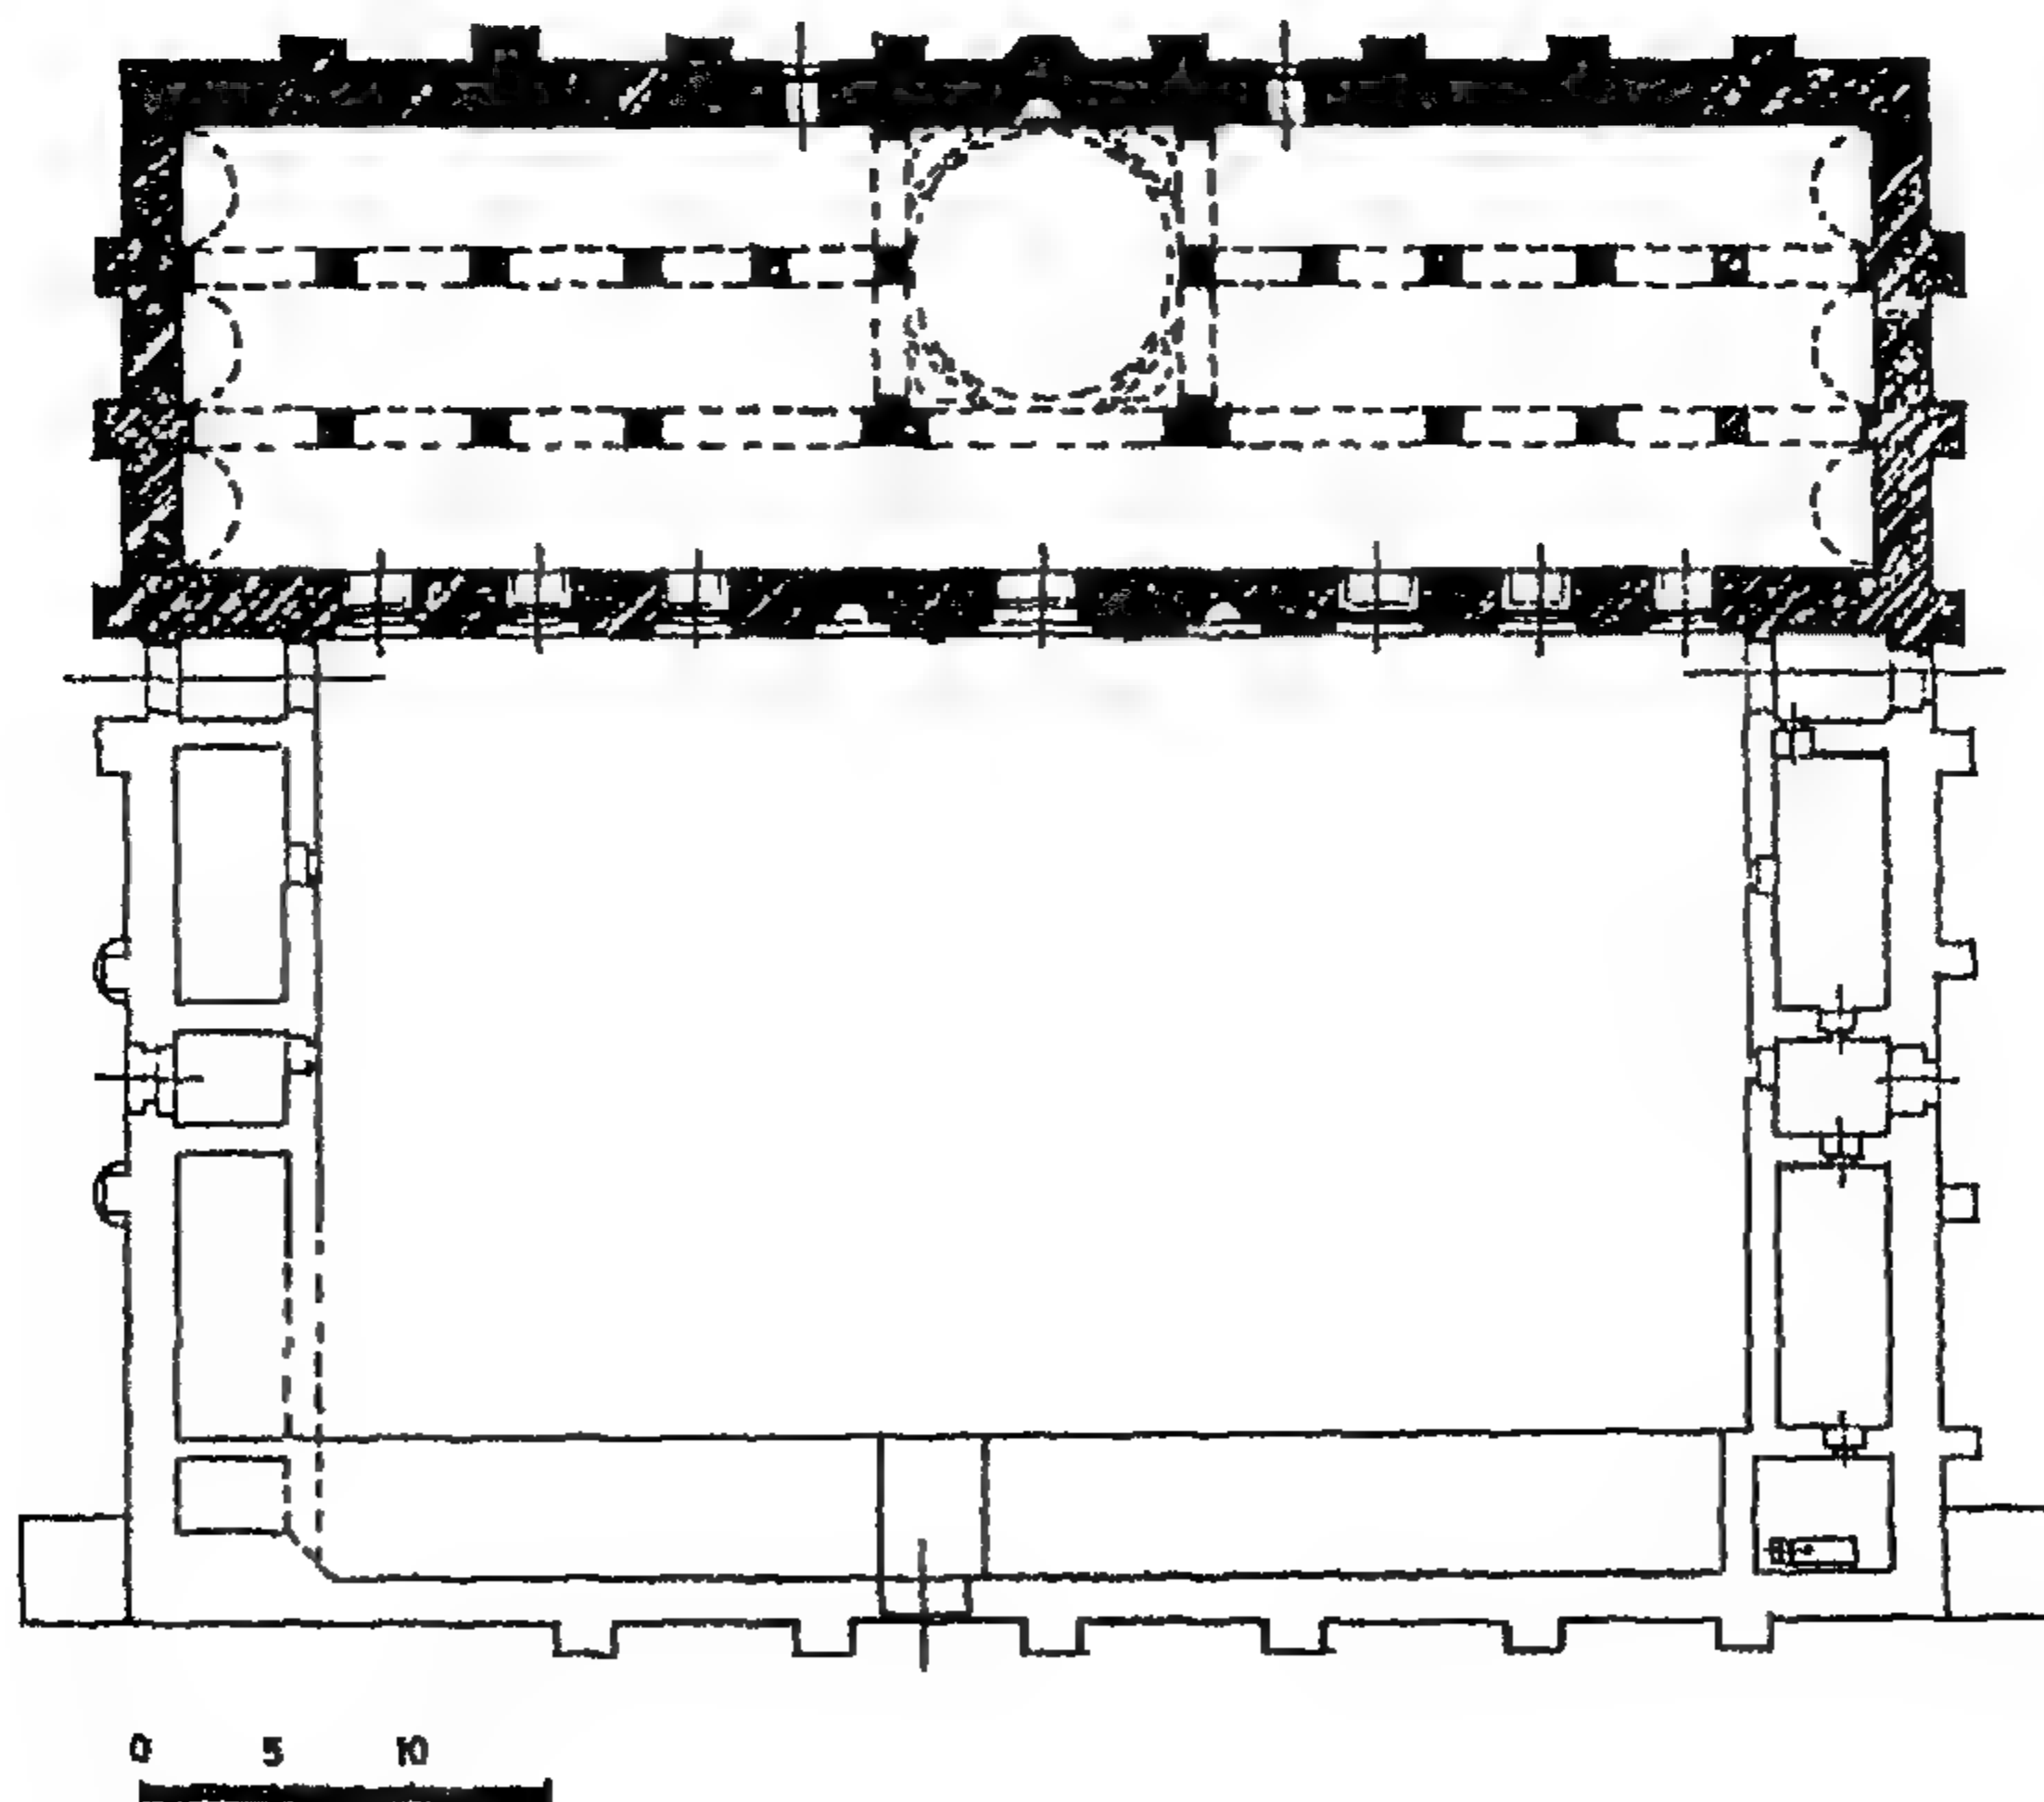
مسقط أفقي لجامع تاريخانه (طارق خانه) بدمغان . (عن : Creswell) .
